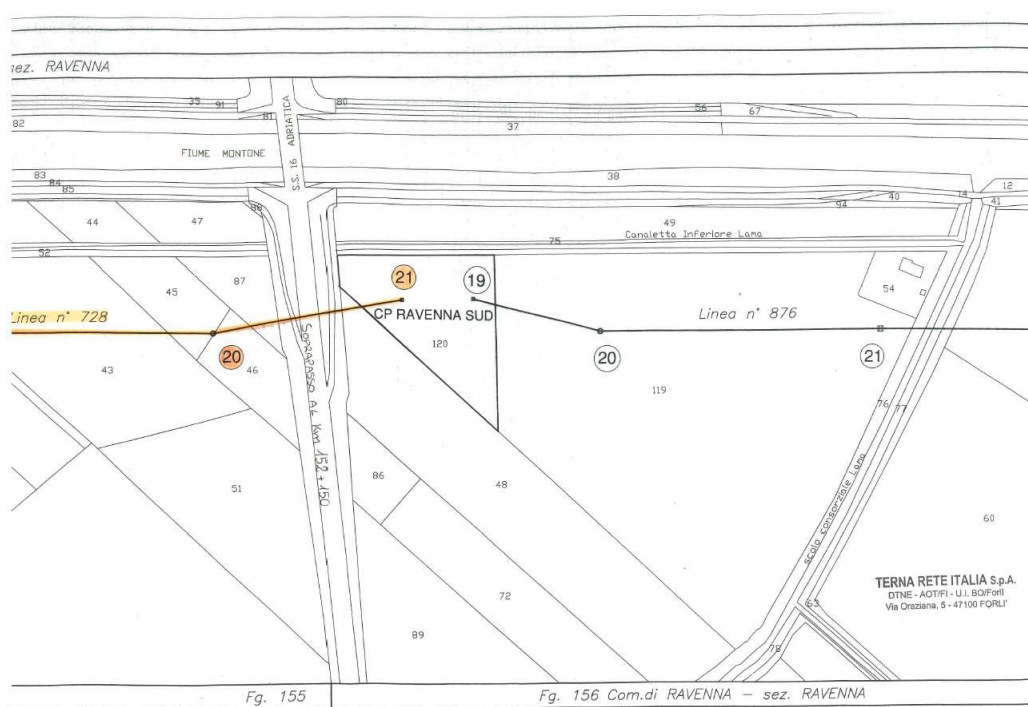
planimetria interferenza - Fonte Terna S.p.A.
